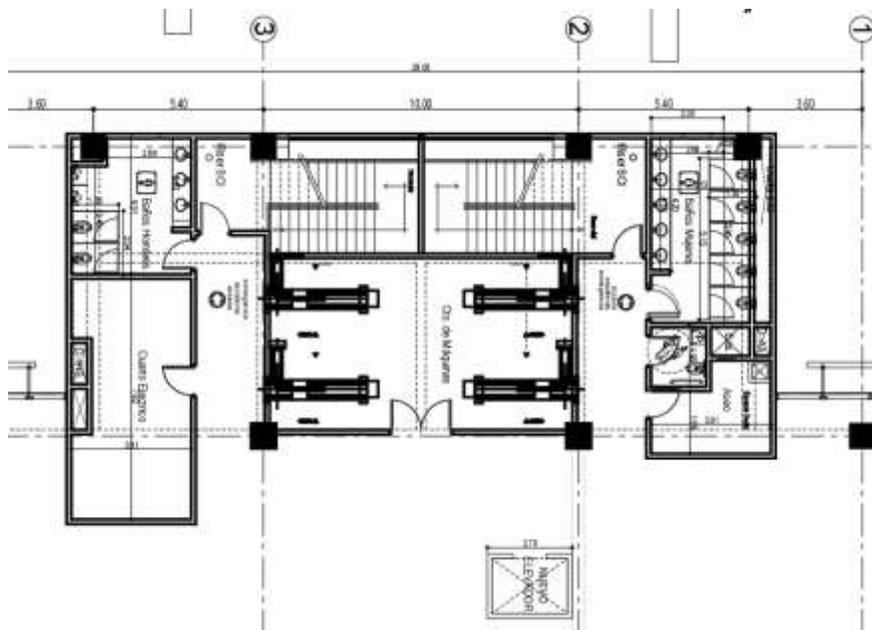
Planta Arquitectónica Actualizada Torre 3 Nivel 7
